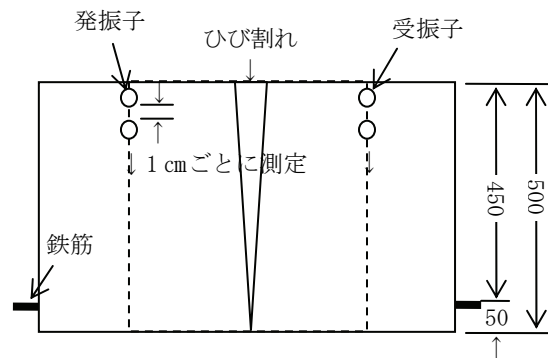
ひび割れ幅と超音波速度の測定方法
